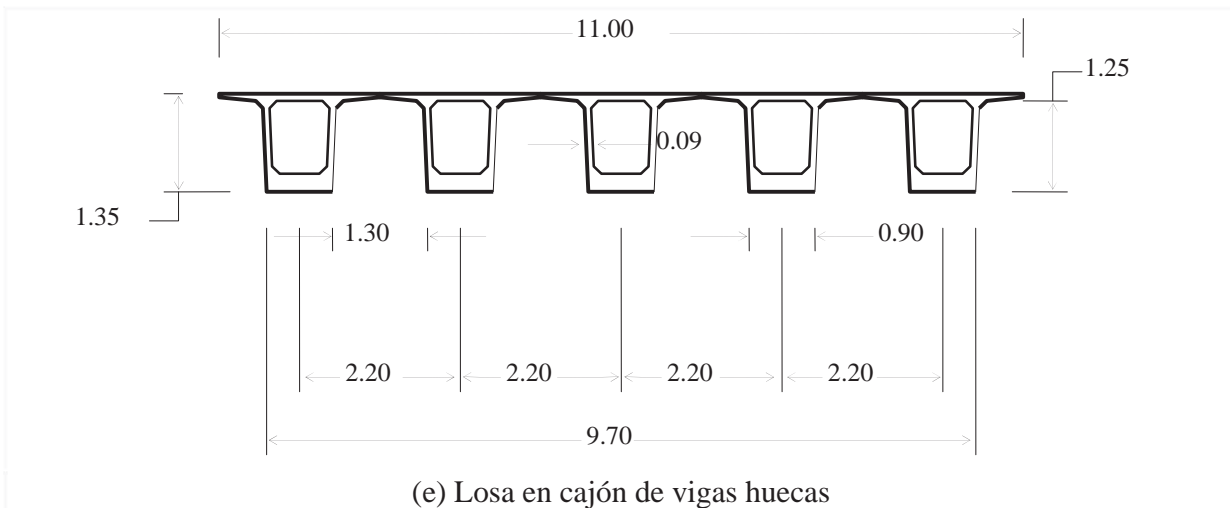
losas apoyadas en sección tipo I y sección tipo cajón (continua)
